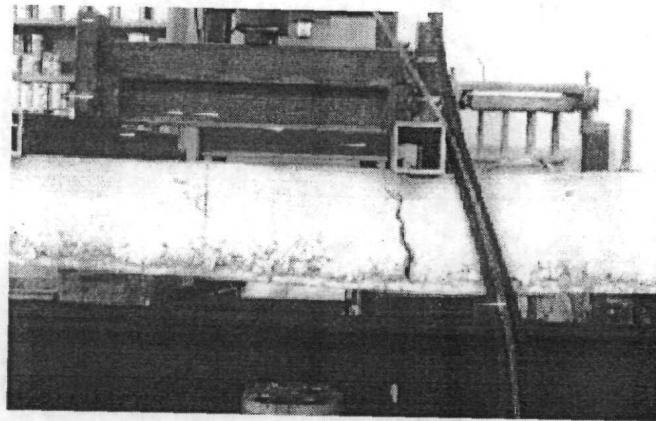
Grieta en tensión diagonal bajo el apoyo izquierdo
